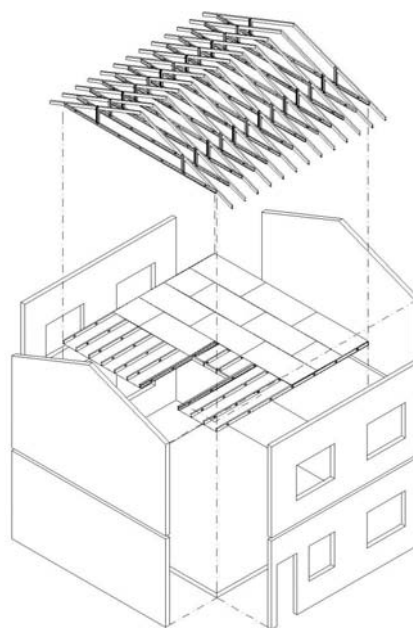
Esquema de construcción tipo “platform” (por pisos). (Fuente: SCI)
